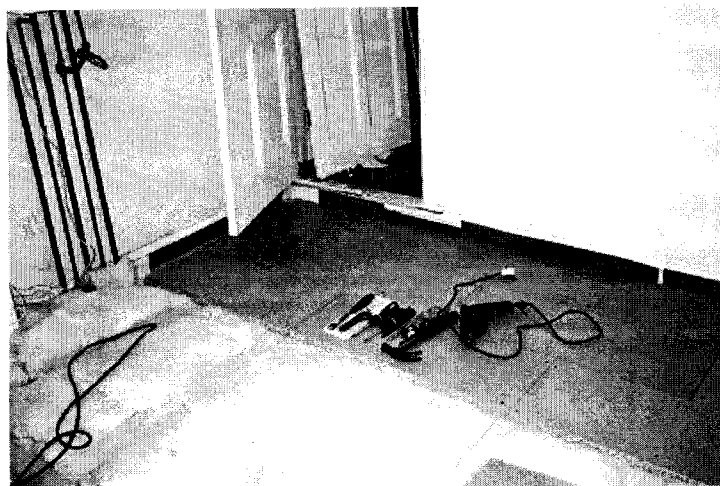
Rangka lantai *raised floor* dari kayu.
